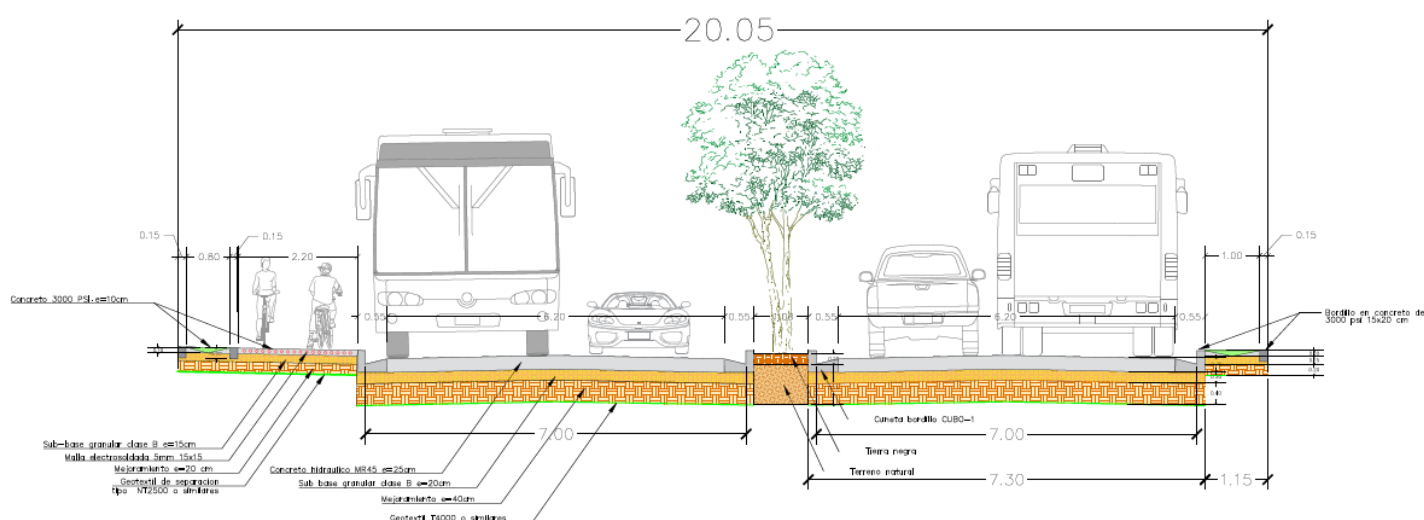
Sección típica calle 40 entre troncal (Riohacha-Maicao) y carrera 7h Eje Vial
